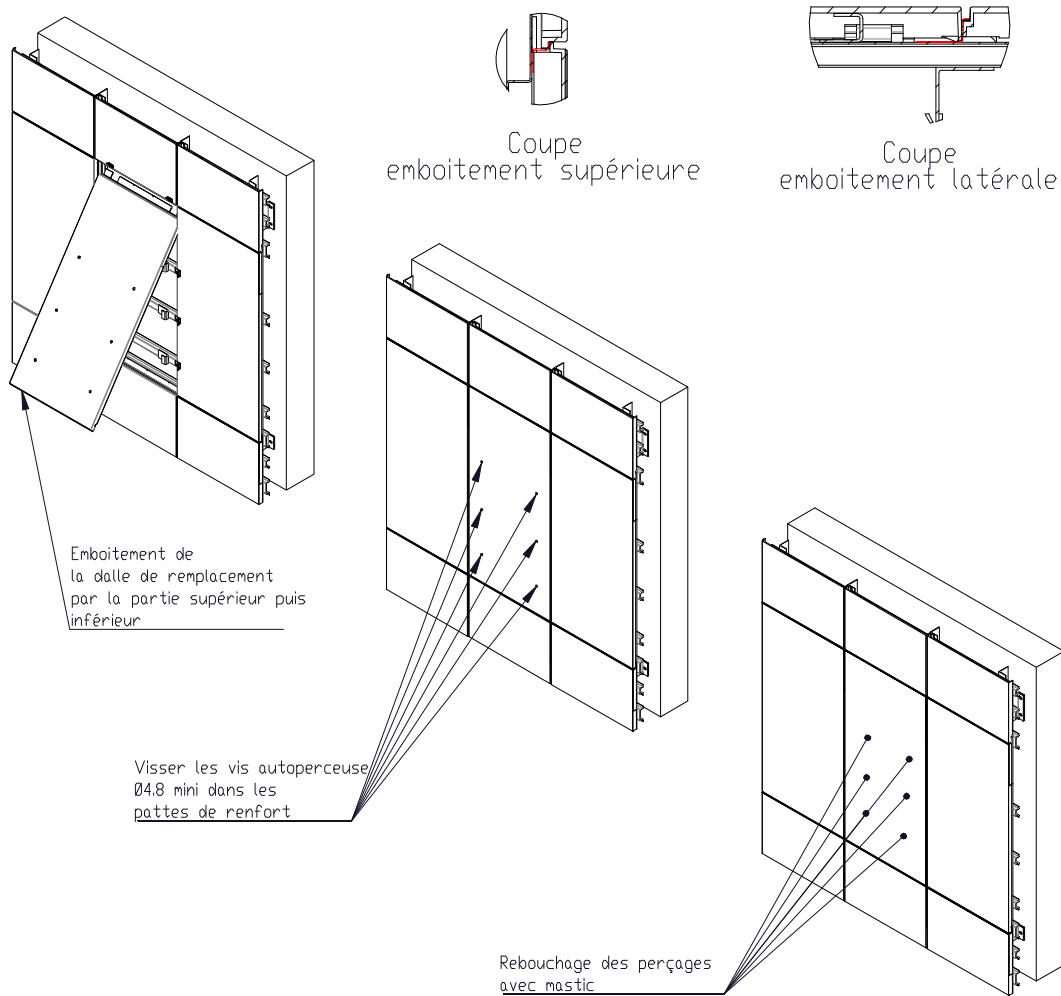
Aquila Bardage 60x120 – Principe de remplacement – Joints Alignés
